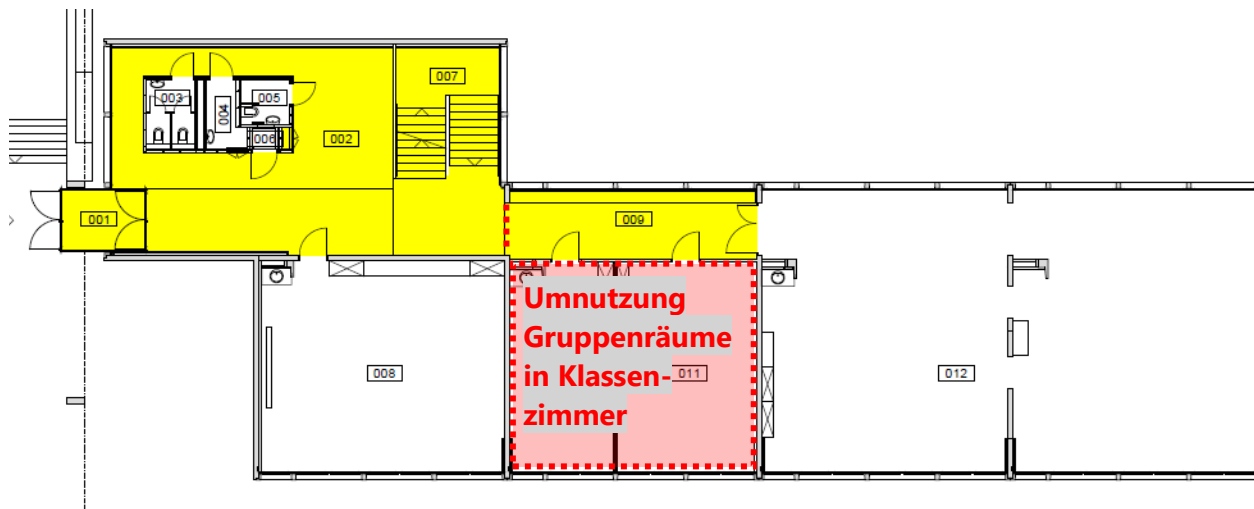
Erdgeschoss Klassentrakt 2 - mit neuem Klassenzimmer und neuem Brandabschnitt
